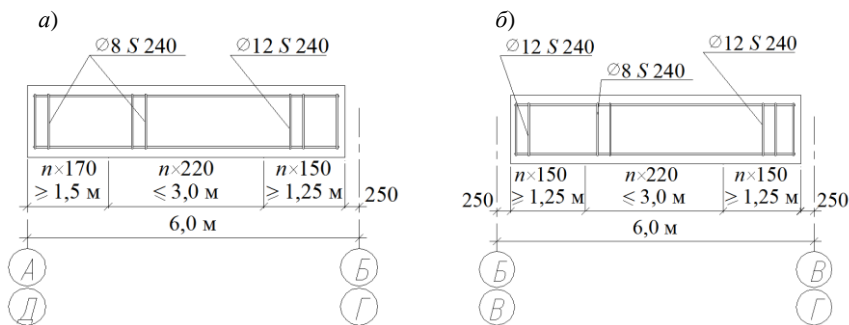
Схема армирования ригеля поперечными стержнями:
